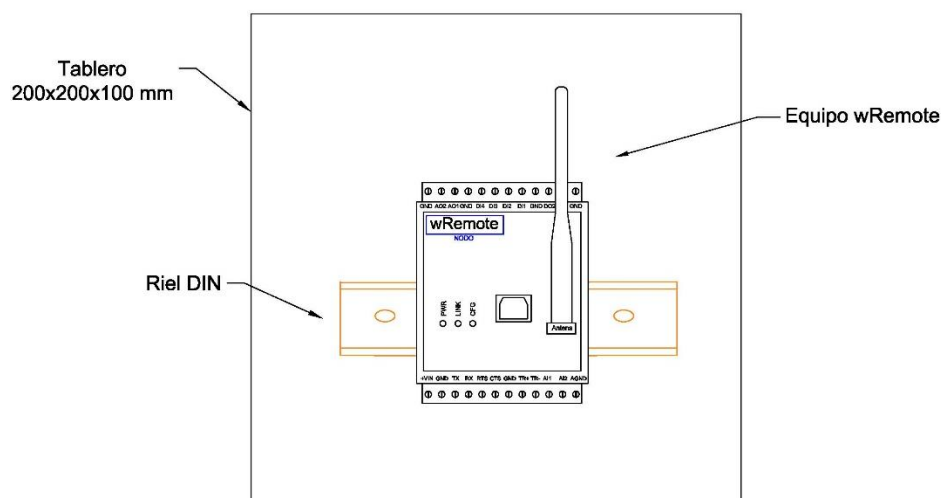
Montaje del equipo wRemote en el tablero de telemetría
